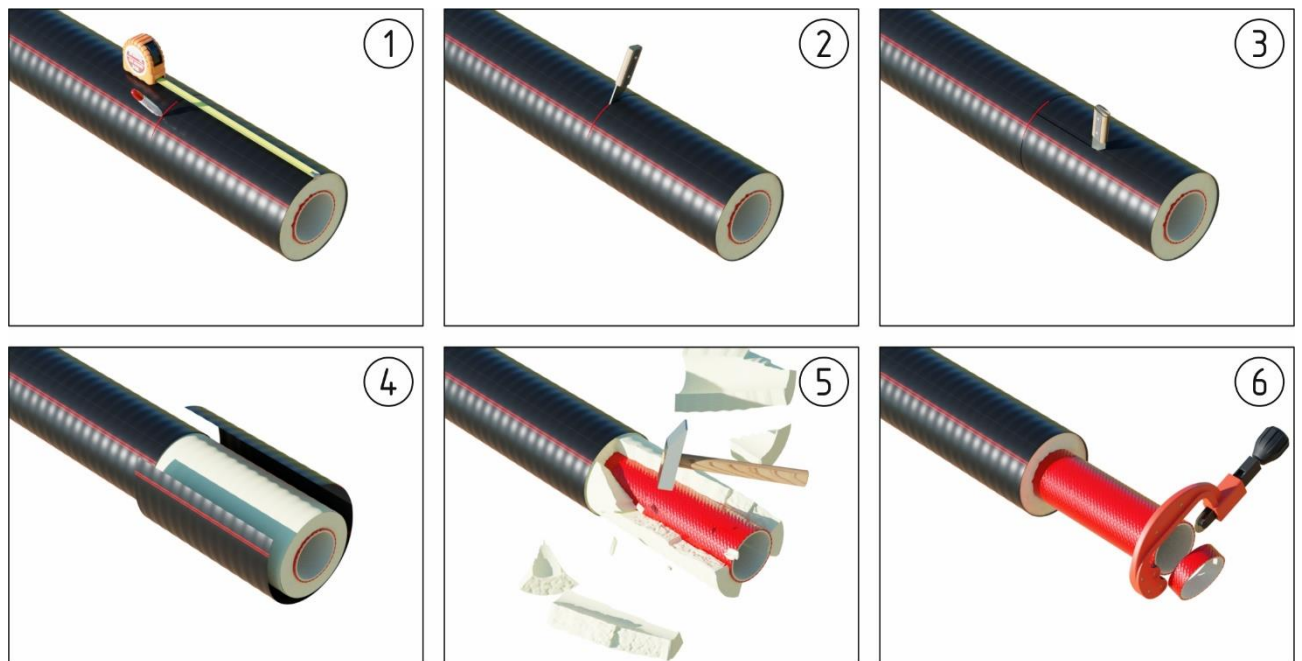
Порядок проведения работ по подготовке трубы к монтажу соединительных элементов
